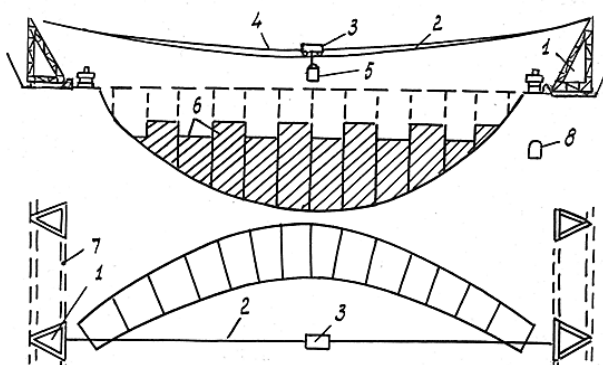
Схема возведения бетонных сооружений с применением кабель-крана:
